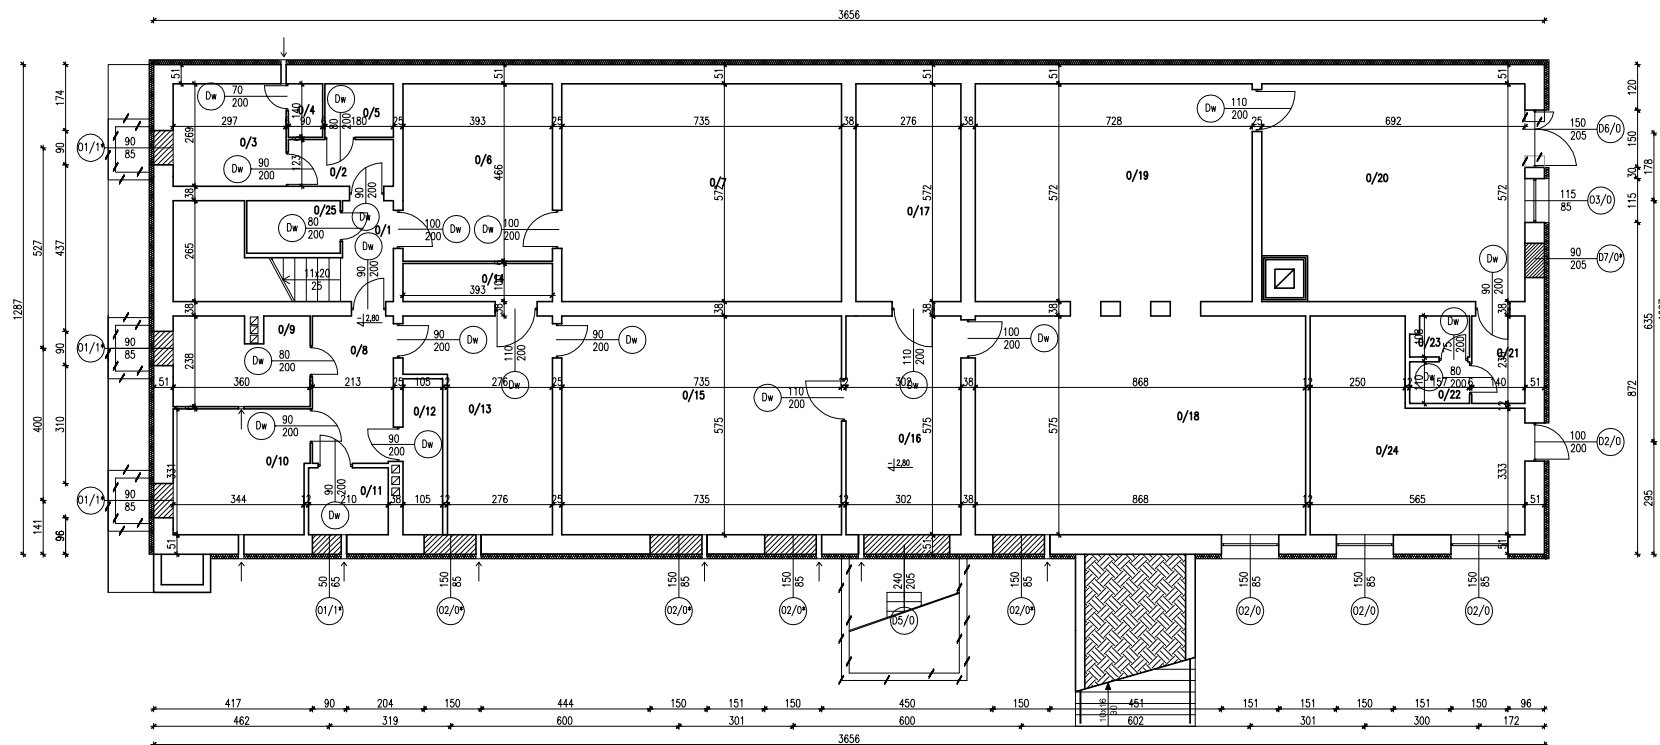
Instalacja gazowa, Rzut piętra, skala 1:100.
